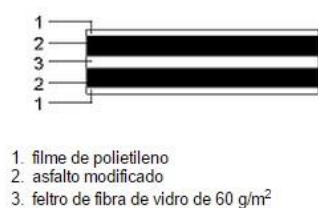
Pormenor da composição da membrana acústica (Danosa M.A.D.4 autoadesiva)
